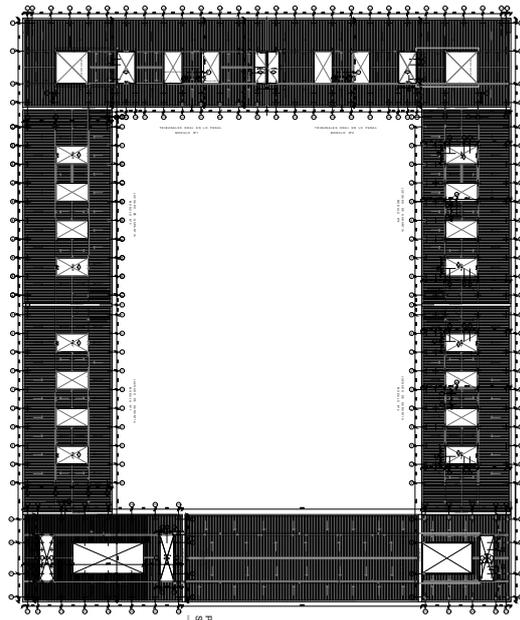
Planta de la cubierta que delimita la plaza cívica CJS.
